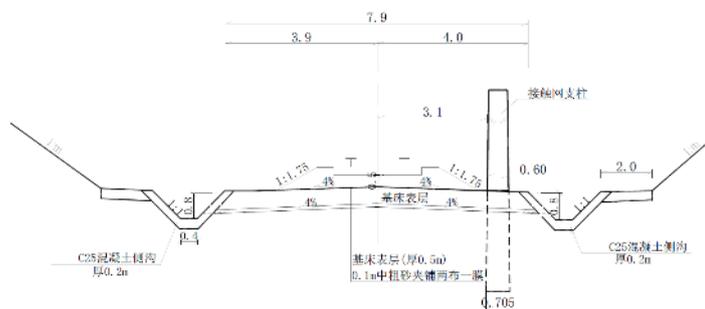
单线有砟轨道路堑标准横断面图（一般土质、软质岩、非膨胀软岩）
